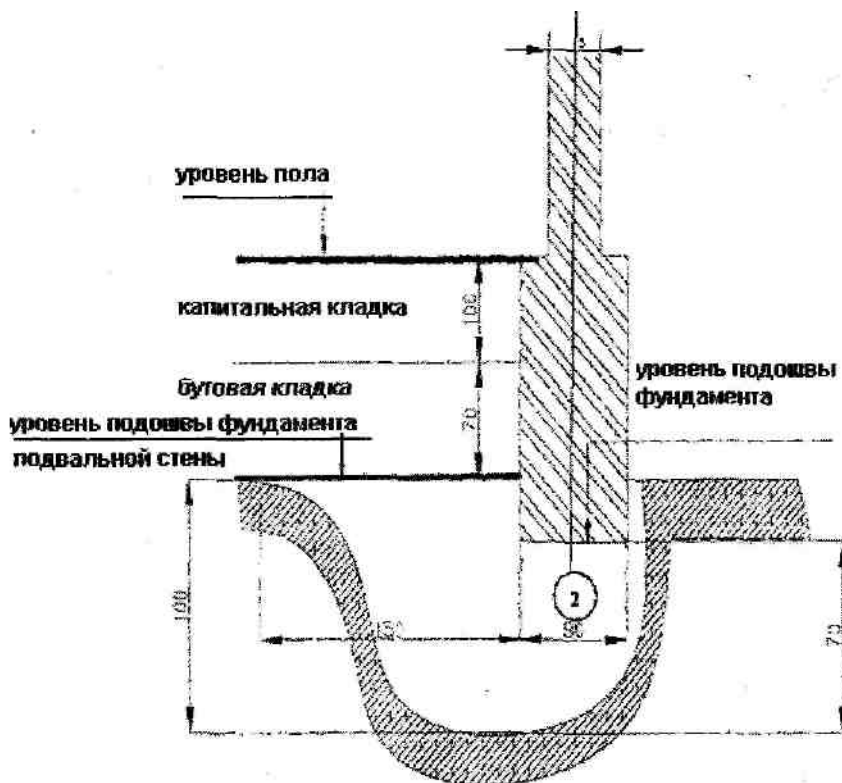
Участок размыва грунта под продольной стеной. Ось 2.
